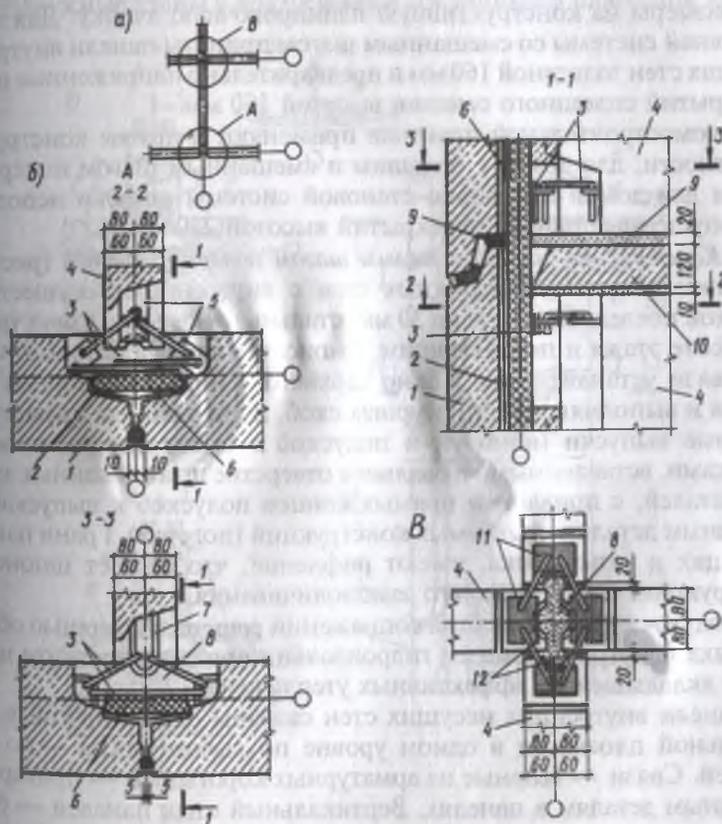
Узлы сопряжений конструктивных элементов крупнопанельных 5...9-этажных зданий с малым шагом несущих поперечных стен:
